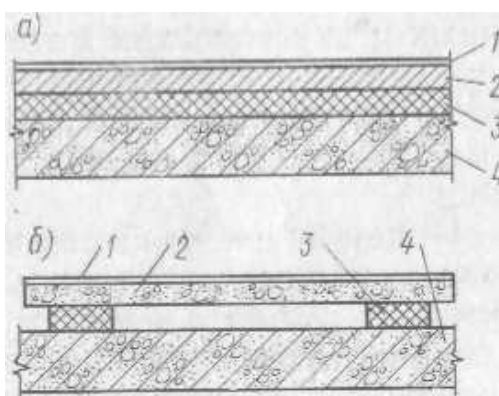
Схема применения звукоизоляционных материалов в междуэтажных перекрытиях:
